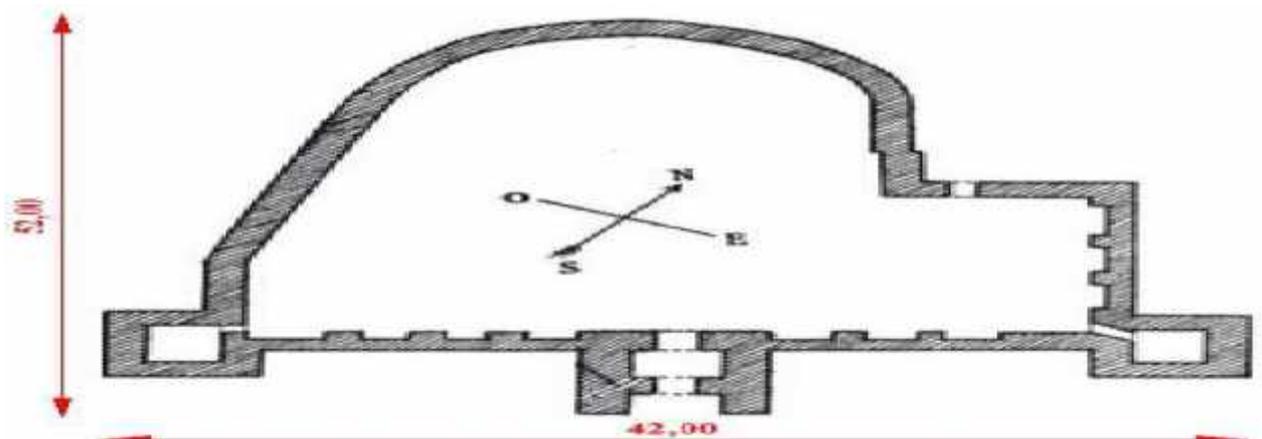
Plan de la forteresse byzantine de Madaure, source : établie par bounasra 1978.
